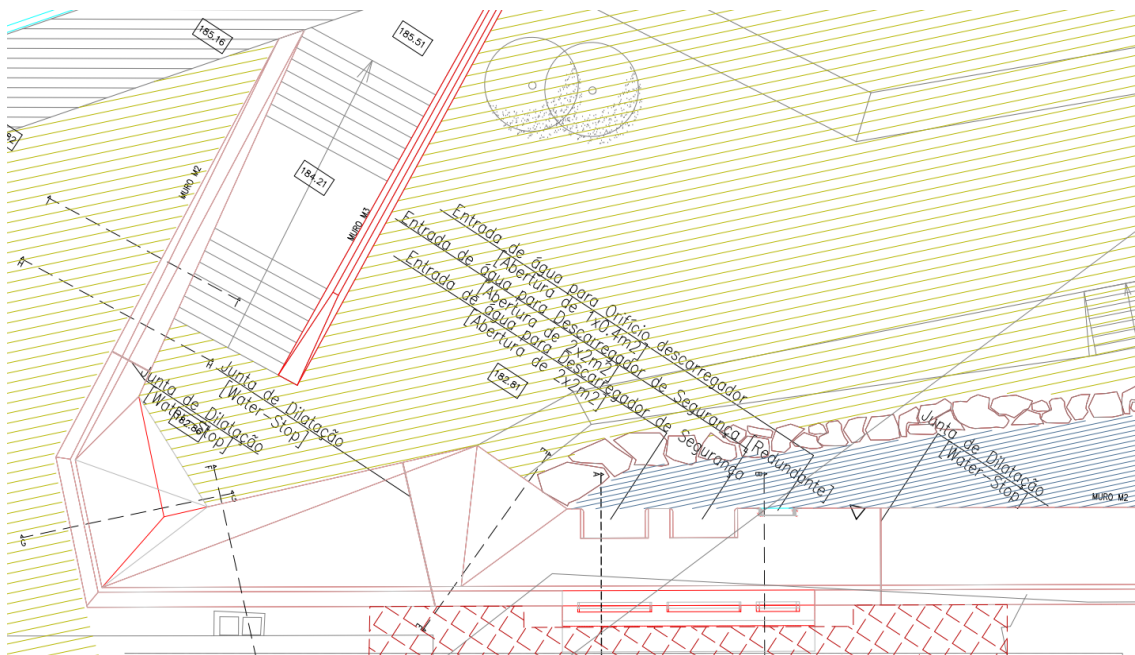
Plano de Estrutural. Estrutura de Retenção de Montante. Fonte: Projegui.
